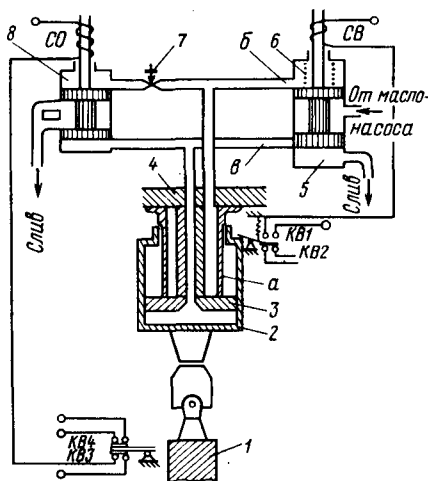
Схема управления масляным приводом плоского затвора: 1 — плоский затвор; 2 — цилиндр; 3 — шток; 4 — опорная конструкция; 5, 8 — золотники; 6 — пружина; 7 — дросселирующее устройство; а, б, в — окна
